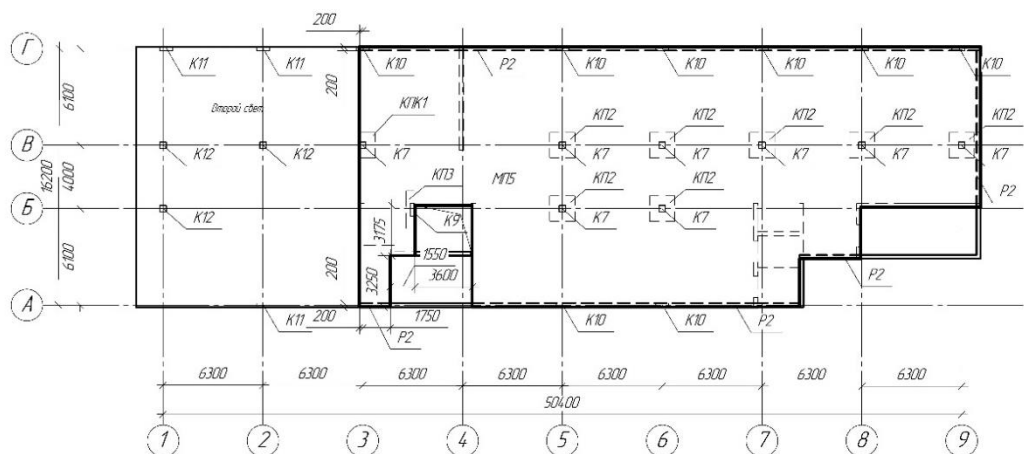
Схема монолитных ж/б колонн, плит перекрытий, капителей и ребер подвала и первого этажа
